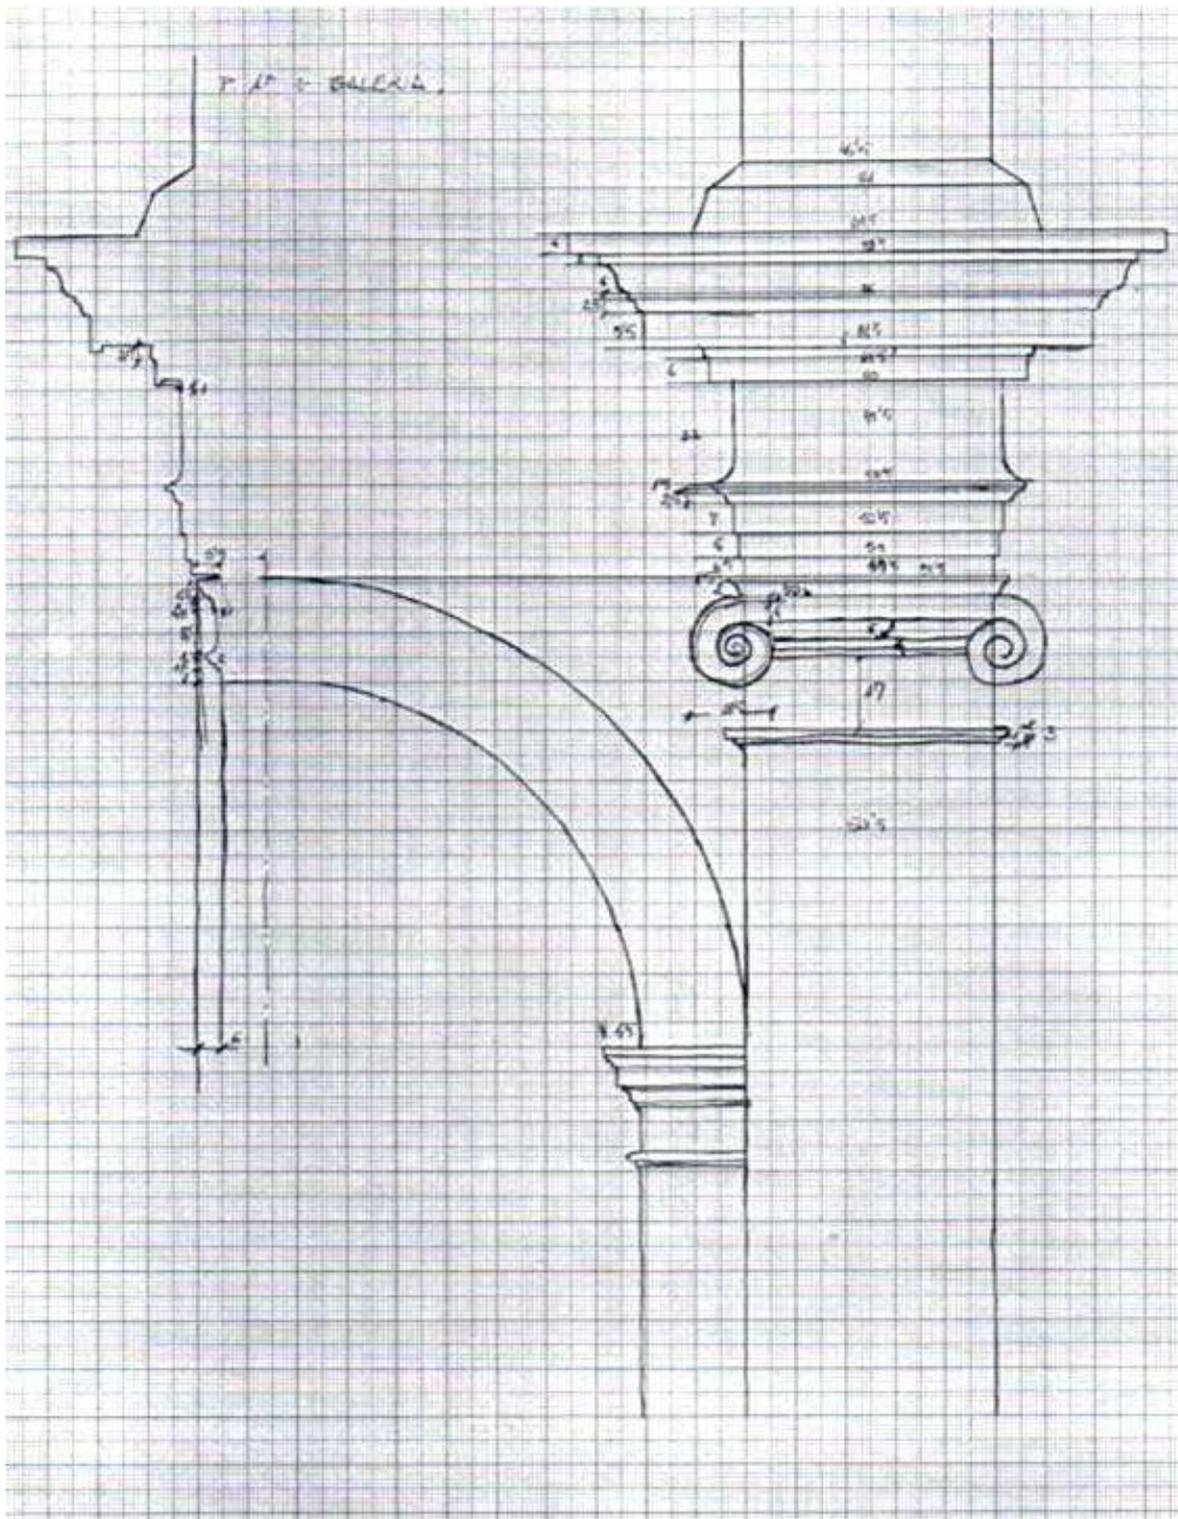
24.4 Toma de datos de pilastras en planta primera.
